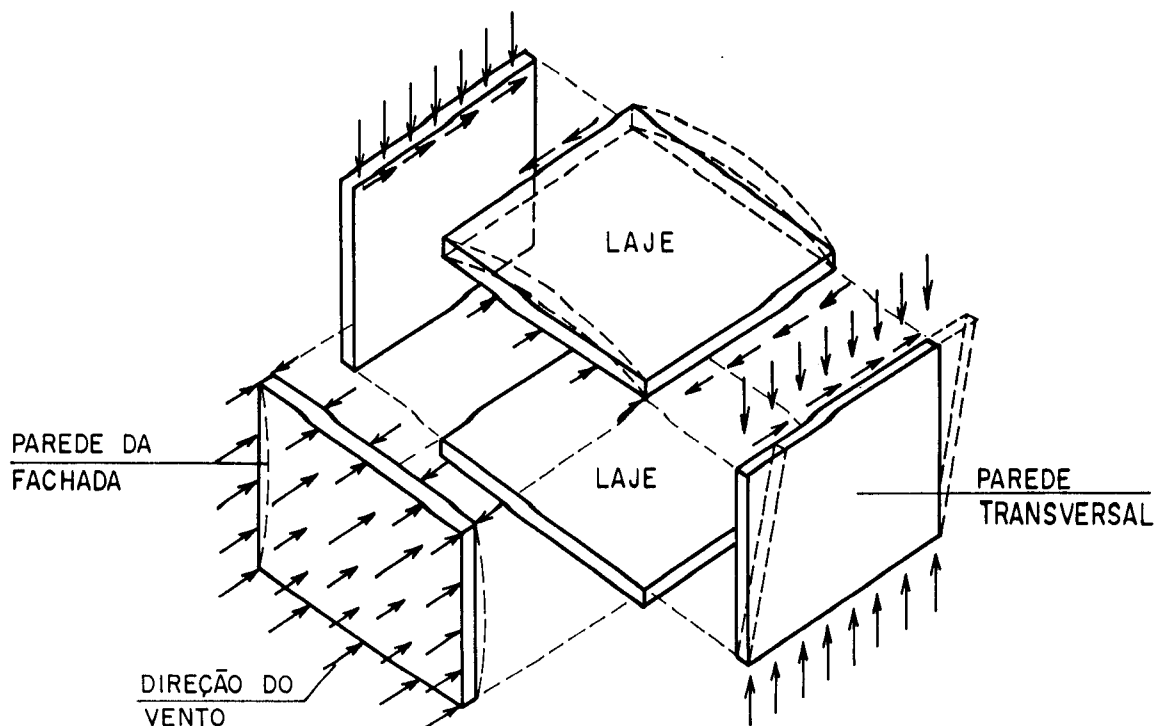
Ação conjunta de paredes e laje sob a ação do vento (Fonte: HENDRY, SINHA & DAVIES [27]).
